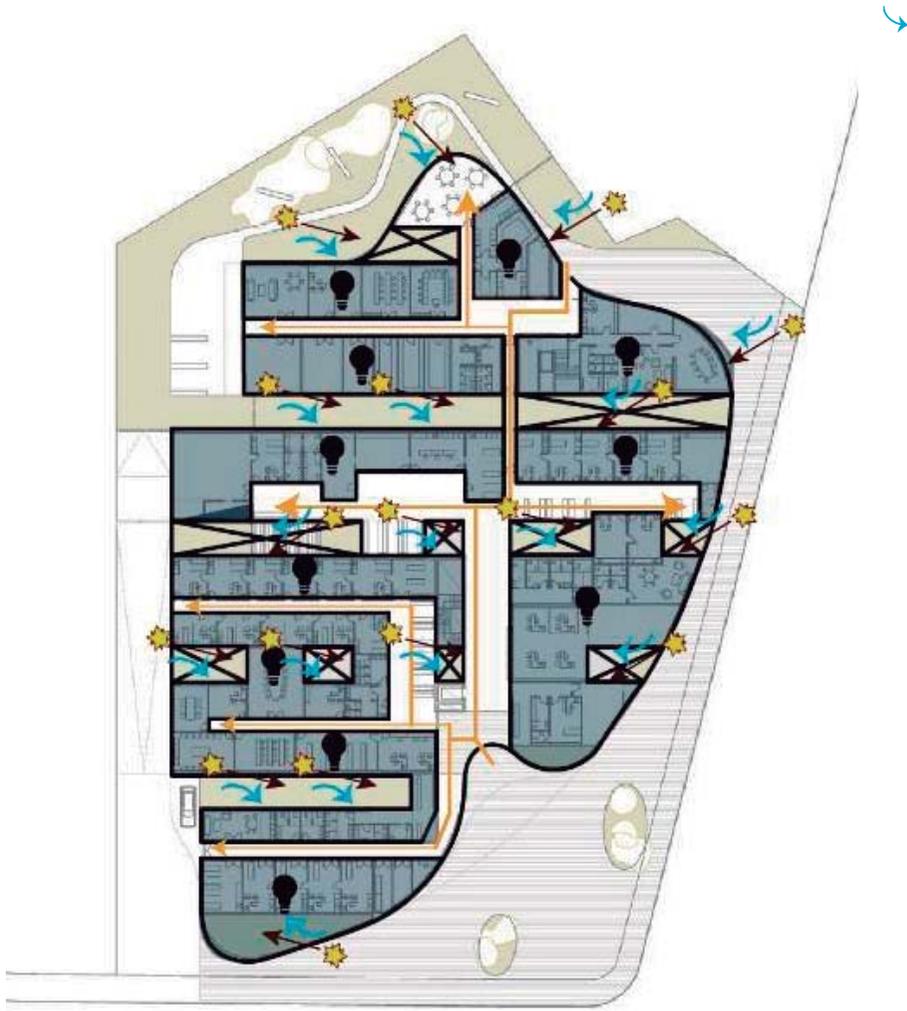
Solución de ventilación e iluminación natural de las plantas arquitectónicas. Autor: A.G.R. Fuente: ArchDaily.
